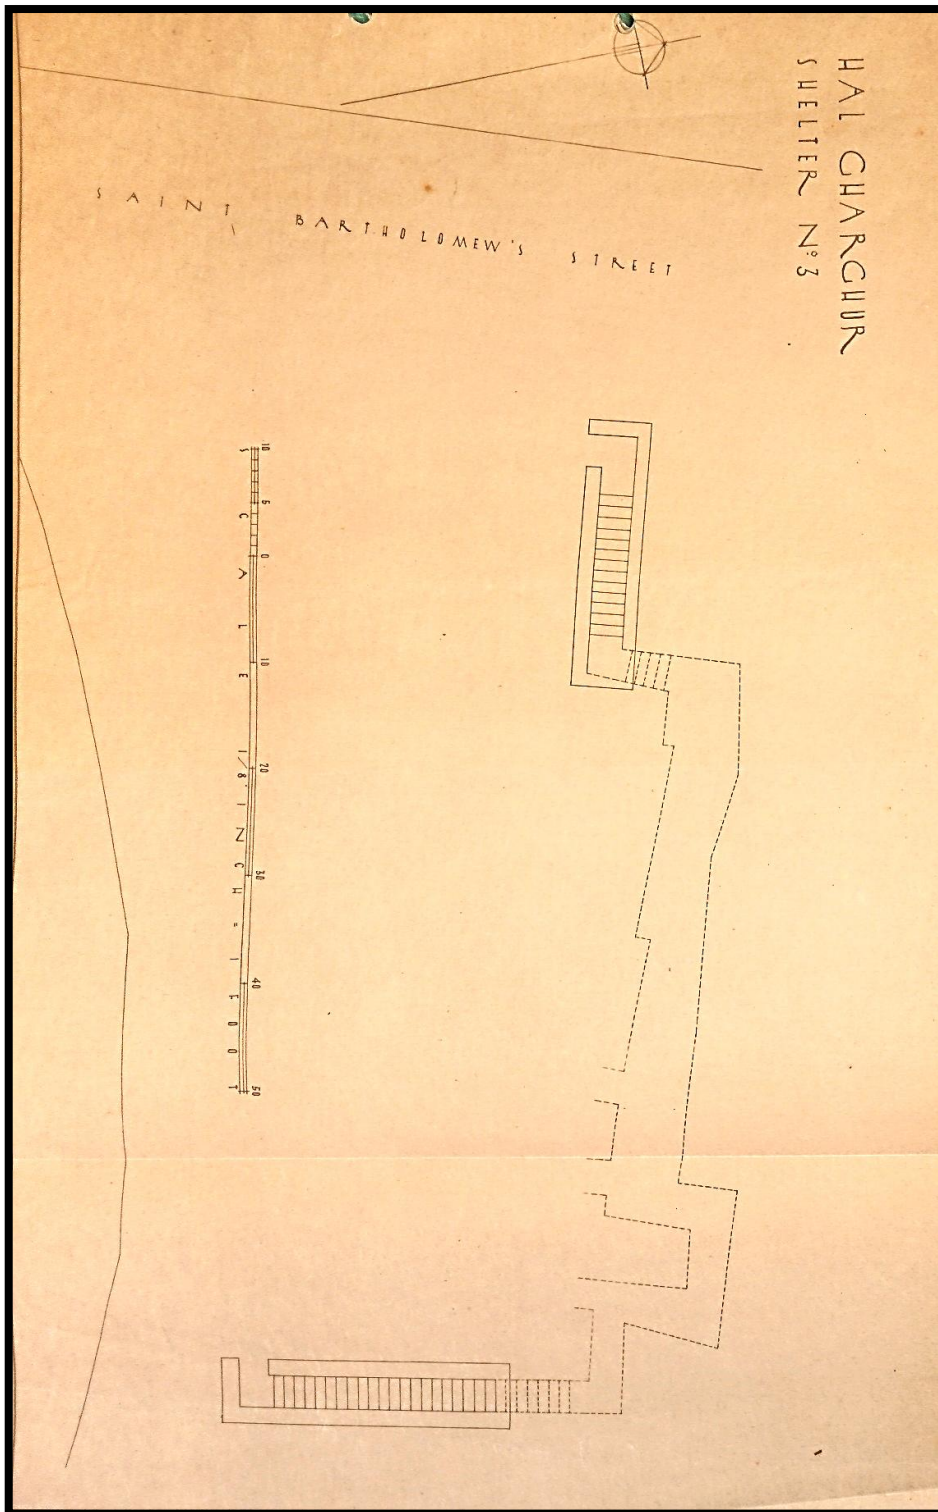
Planta do Abrigo nº3 "Saint Bartholomew's Street."
